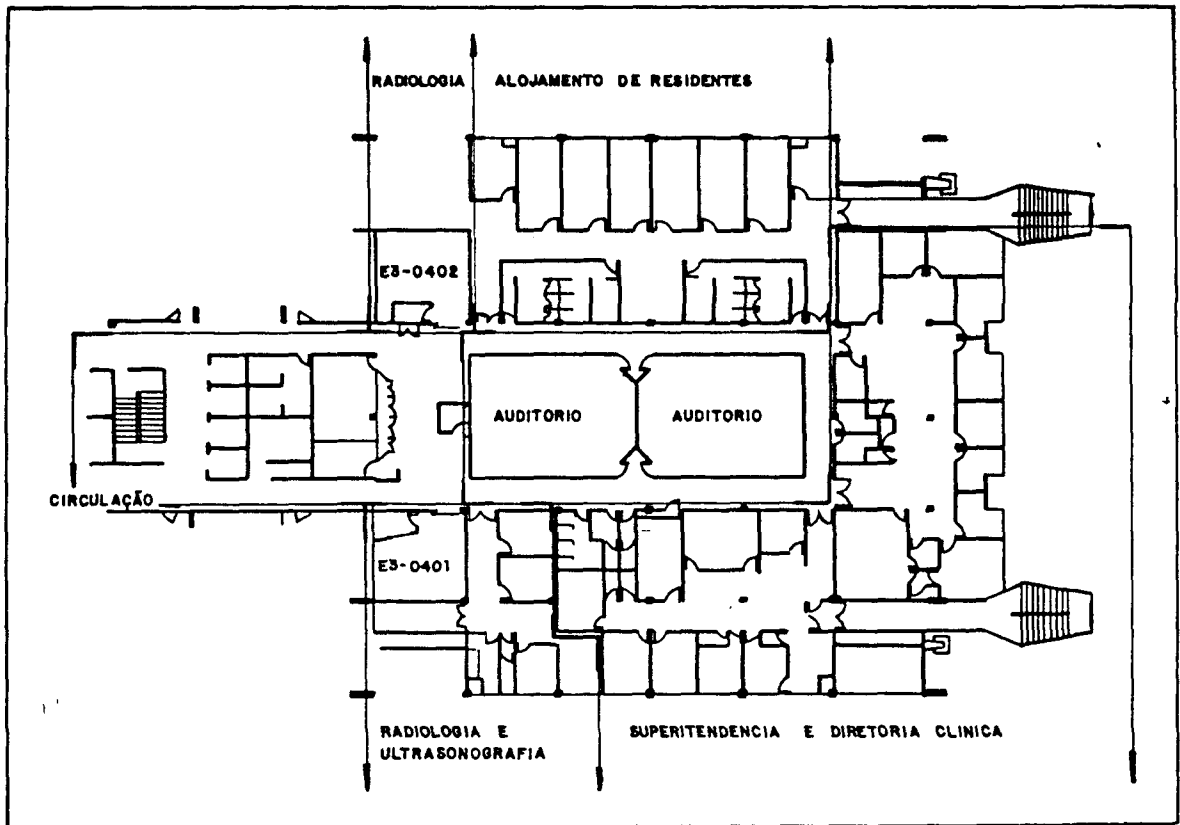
PLANTA BAIXA DO BLOCO E3 DO HC
